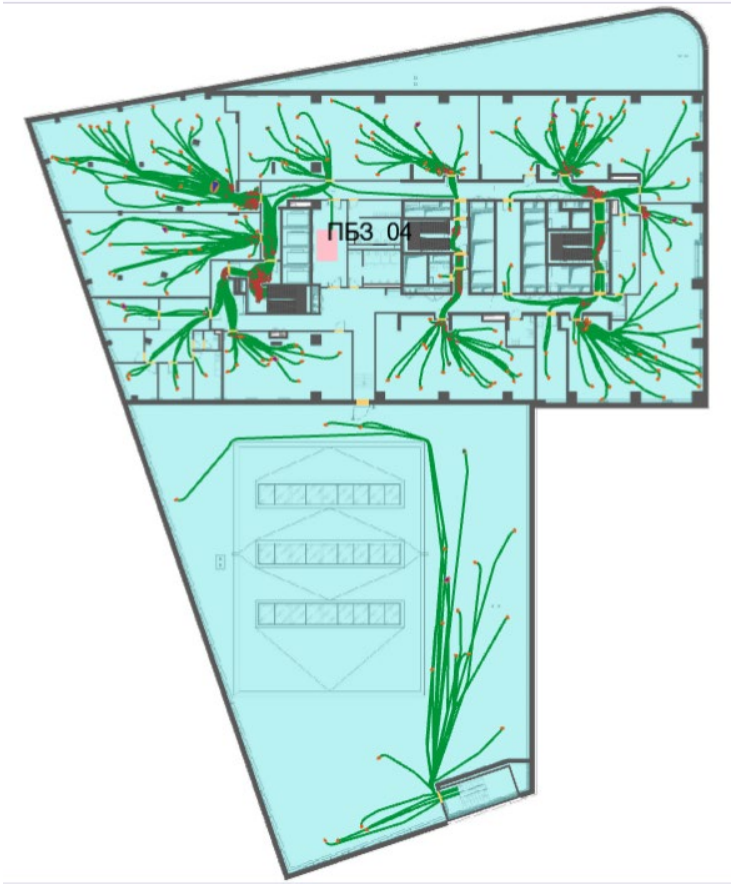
План 4-го этажа и нанесенная на него расчетная (принципиальная) схема эвакуации
